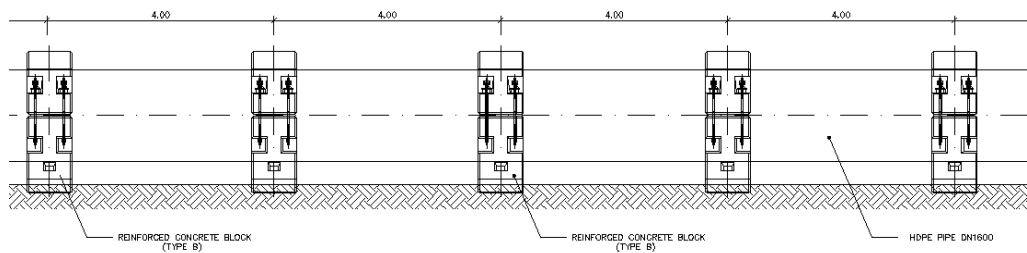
Troço apoiado. Perfil longitudinal tipo
